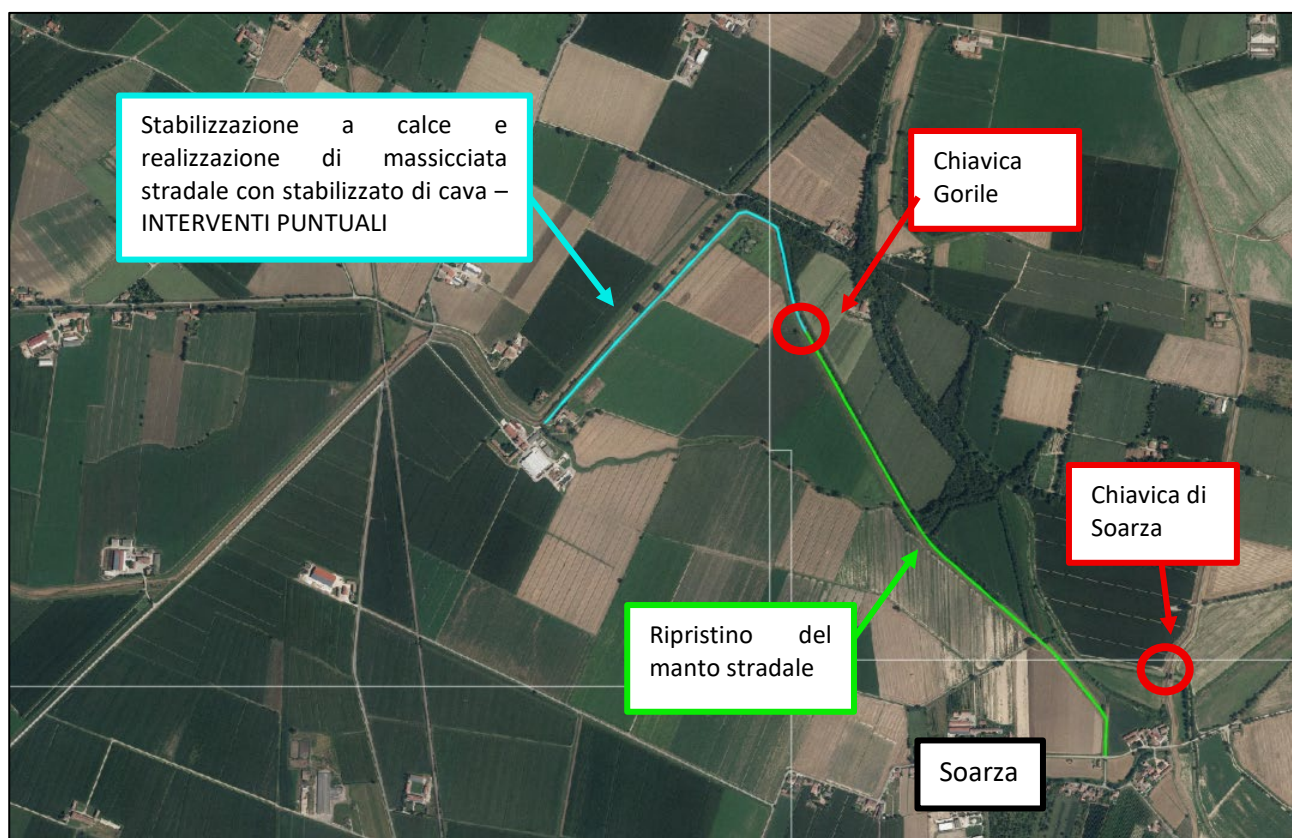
Colatore Fontana – Realizzazione/sistemazione della pista di sommità arginale - Tratti oggetto di intervento.
